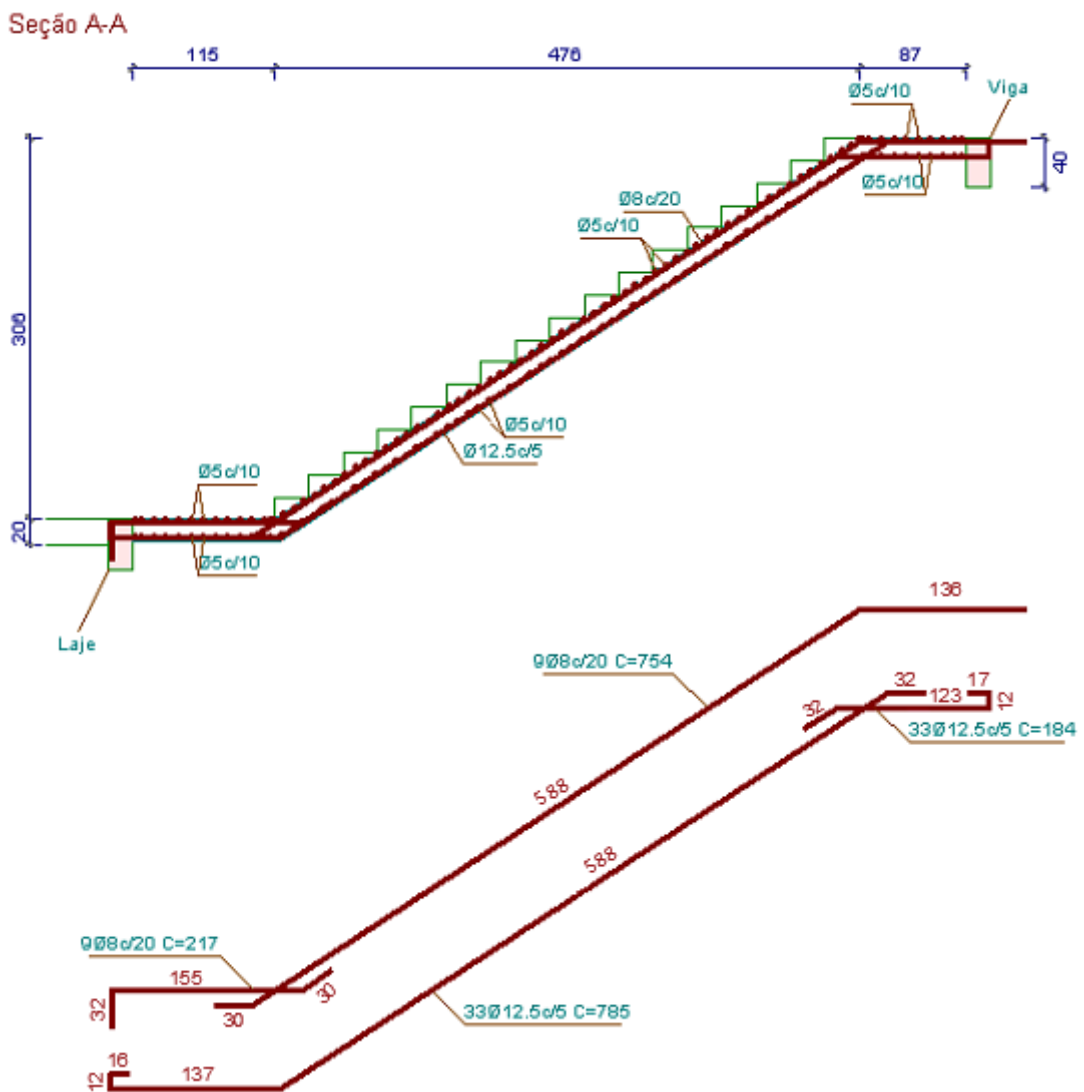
Corte AA: Detalhamento das armaduras longitudinais (Fonte: CYPECAD).
